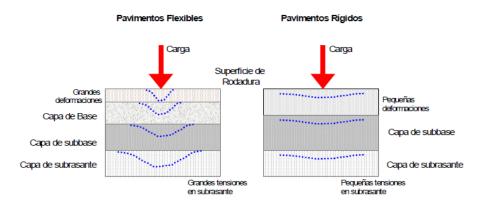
Esquema del comportamiento de Pavimentos flexibles y rígido Fuente: Manual Centroamericano para el diseño de Pavimentos
